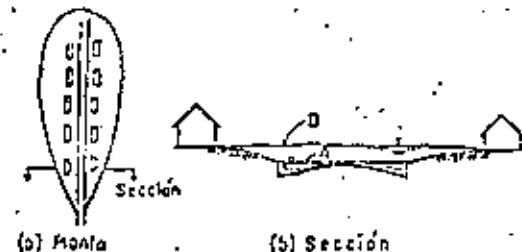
DESAGUE URBANO SIMPLE, PLANTA Y CORTE TRANSVERSAL.
